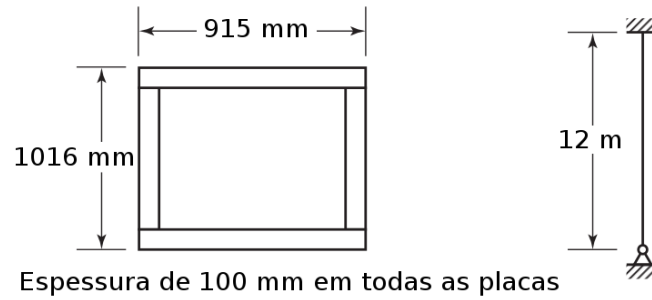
Esquema da seção do perfil construído e da coluna.
